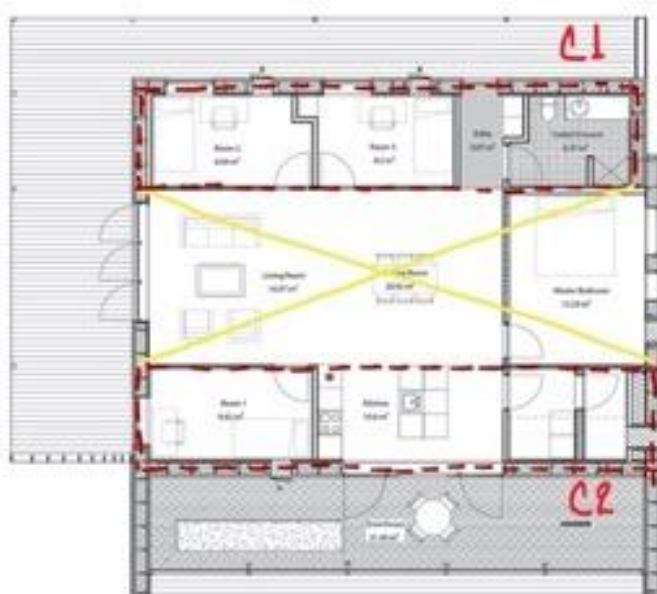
Planta arquitectónica de la vivienda. Archdaily (2014). En rojo, los contenedores.
